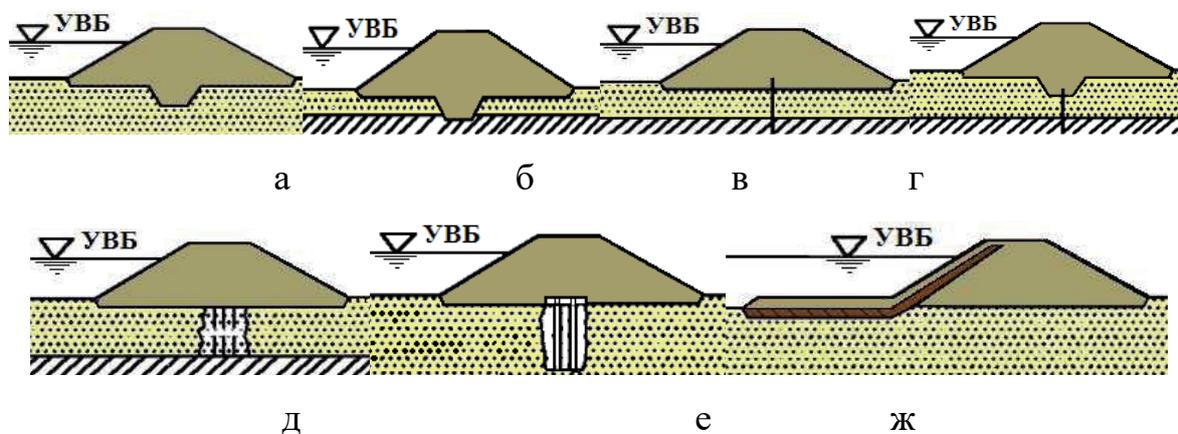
Схемы сопряжения земляных плотин с основанием и ПФУ
